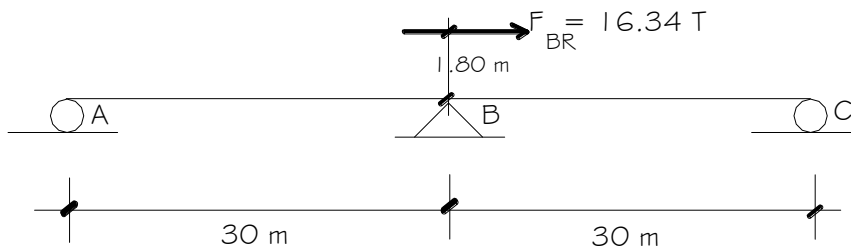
Fuerza de frenado actuando sobre el puente
